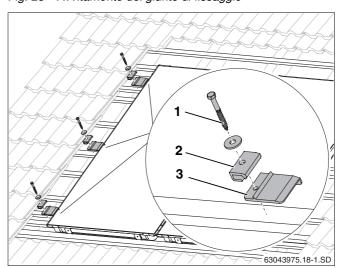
Montaggio del terminale di fissaggio di sinistra
